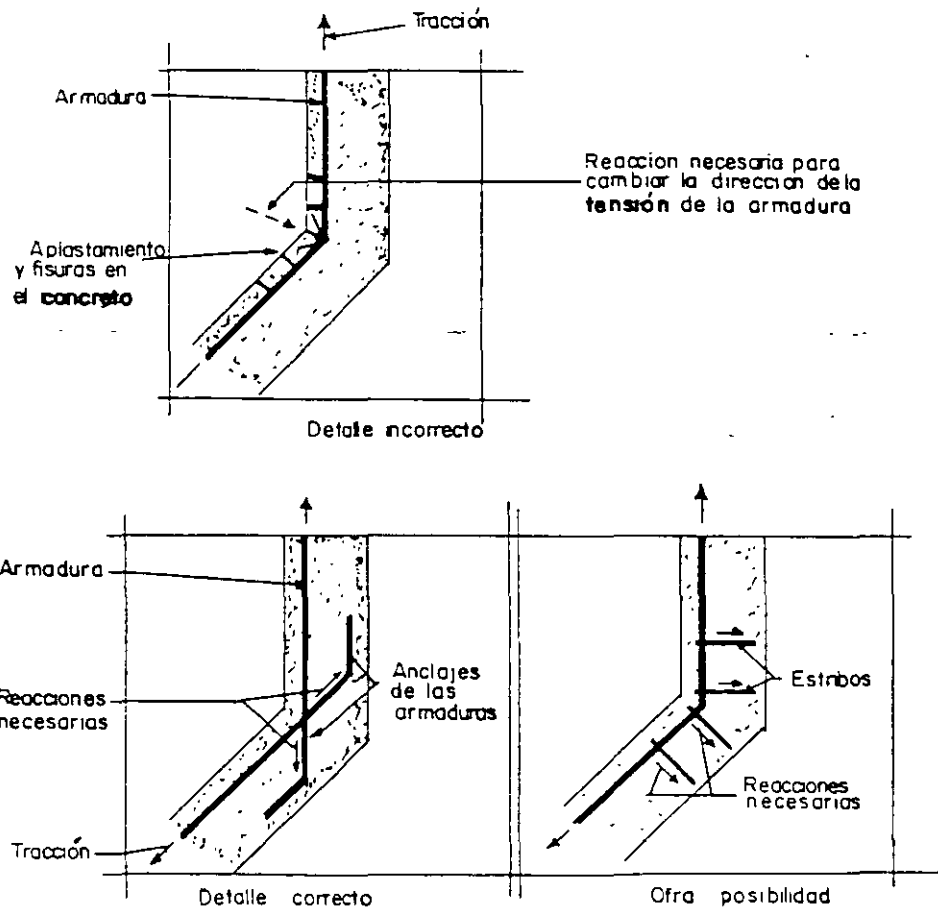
Causa del aplastamiento y fisuración de un ángulo entrante
